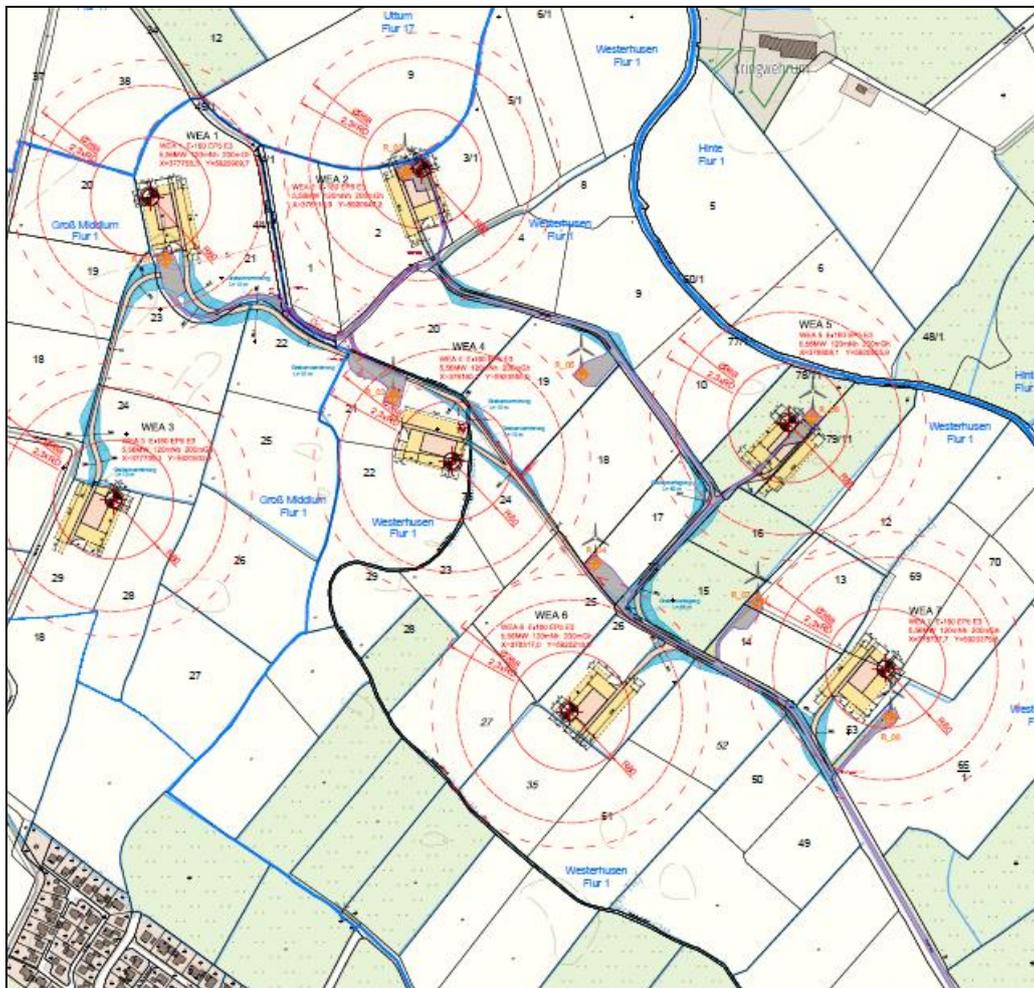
Lageplan der geplanten WEA inkl. Zuwegung und Bauflächen
